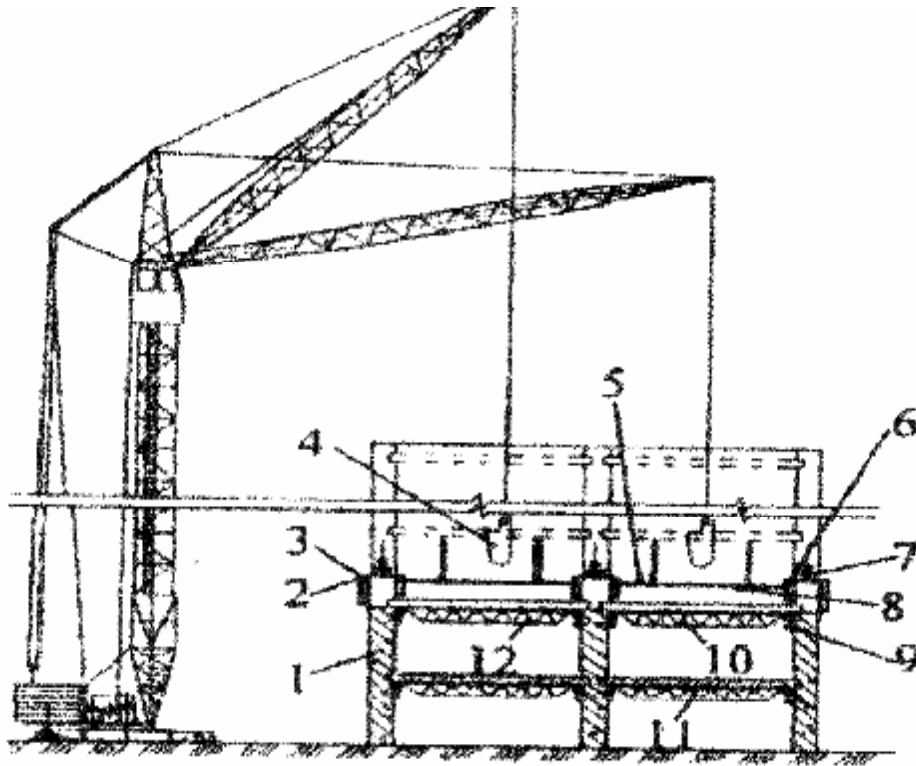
Бетонування міжповерхових перекриттів циклічним методом: 1 – монолітні стіни; 2 – домкратна рама; 3 – зовнішні поздовжні щити; 4 – баддя для подачі бетонної суміші; 5 – робоча підлога; 6 – внутрішні опалубочні щити; 7 – гідродомкрат; 8 – щити робочого стола; 9 – анкери для кріплення прогону; 10 – прогін у вигляді ферми; 11 – монолітне перекриття; 12 – опалубка монолітного перекриття
